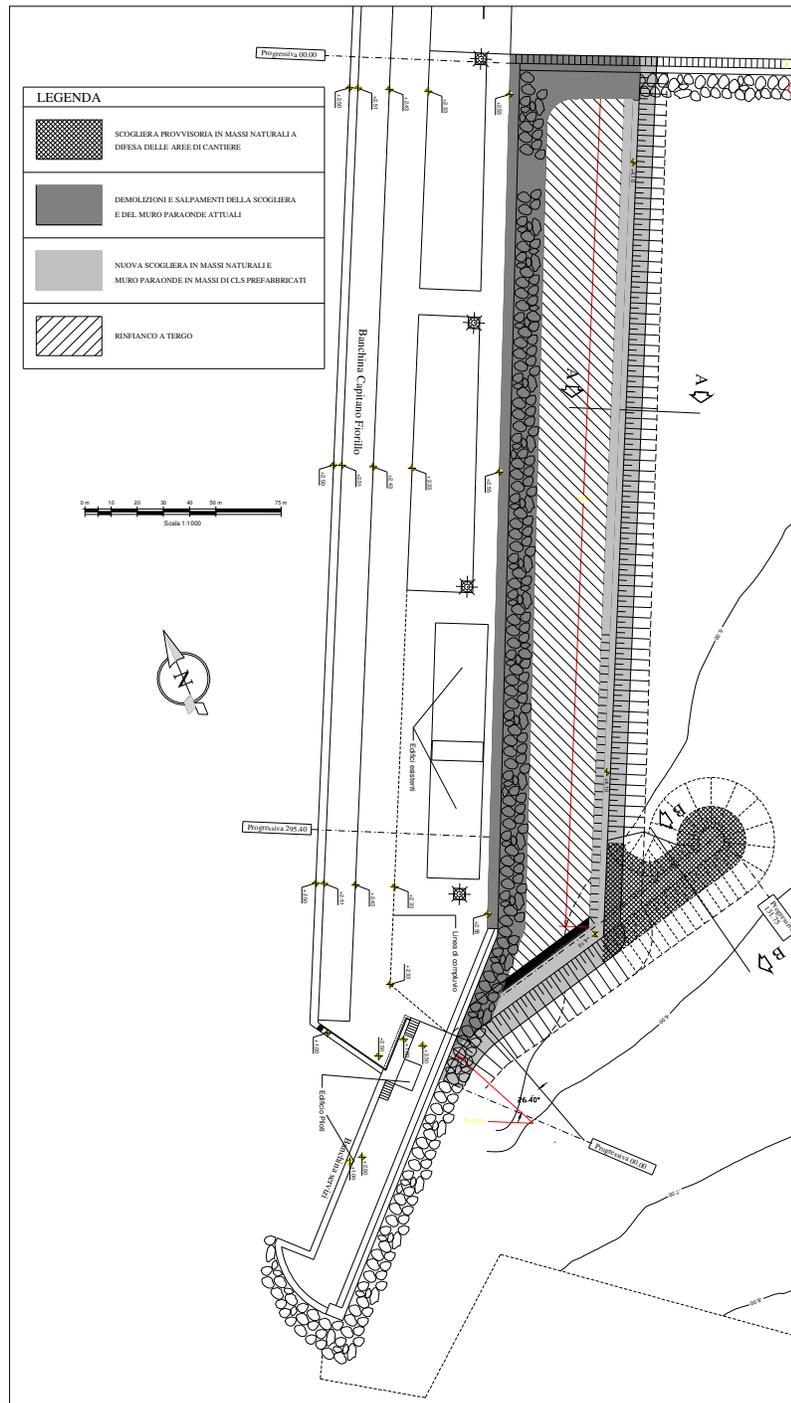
Planimetria della nuova opera di protezione lato mare del molo di levante
